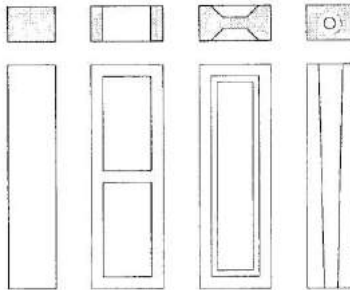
Penampang balok pracetak (Ervianto 2006)
